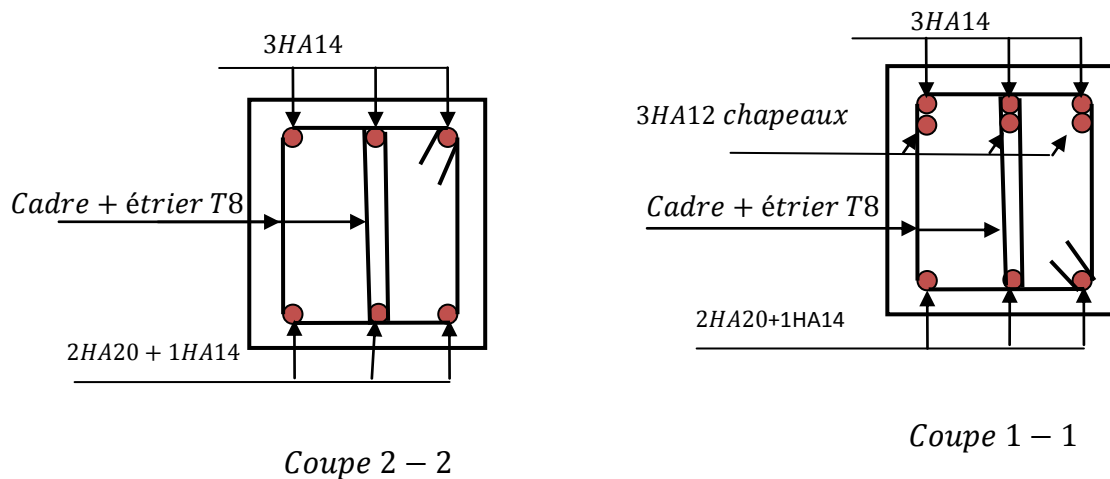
Schéma de ferrailage des poutres secondaires (3^{ème} au 12^{ème} étage)
